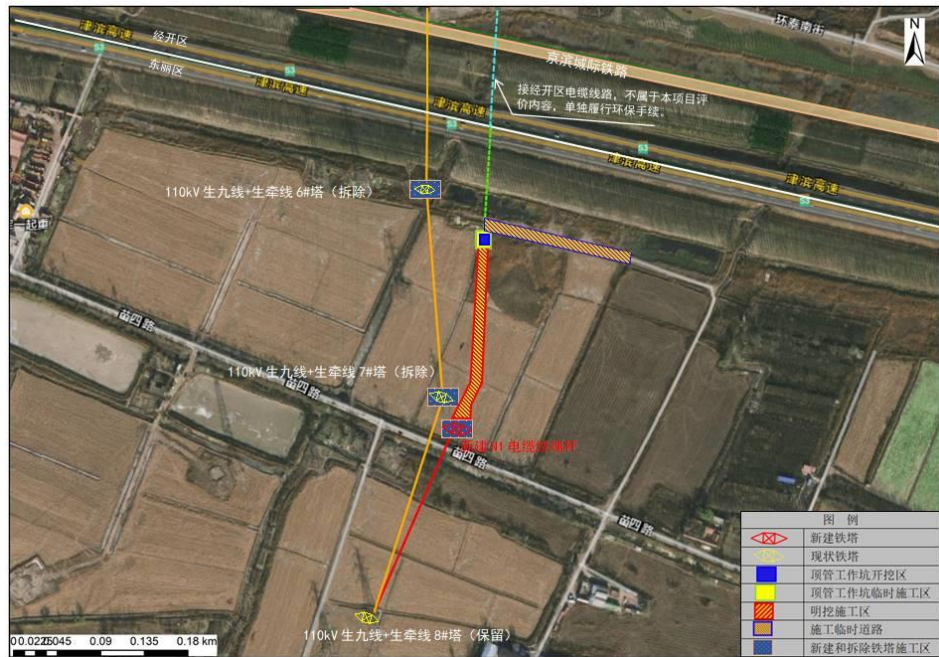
110kV 生牵、生九线路迁改线路施工平面布置图
